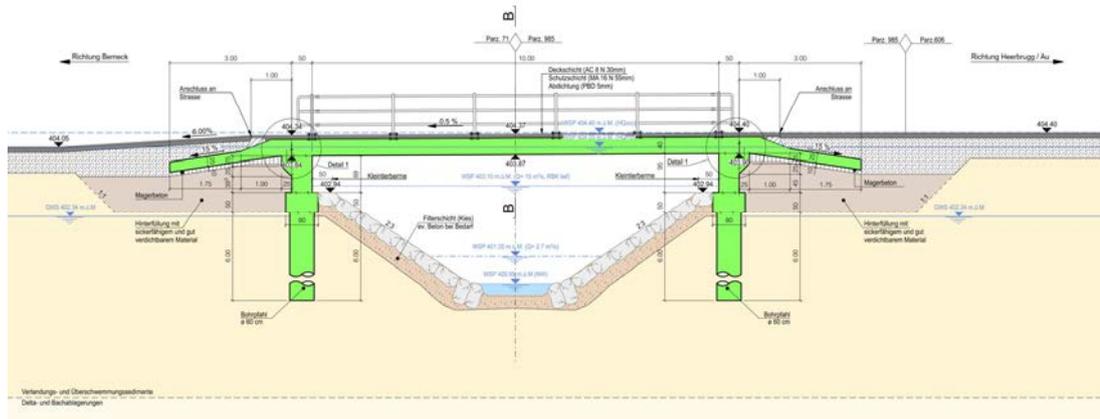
Vertikale Linienführung Brücke Kloterenstrasse, Äächeli
